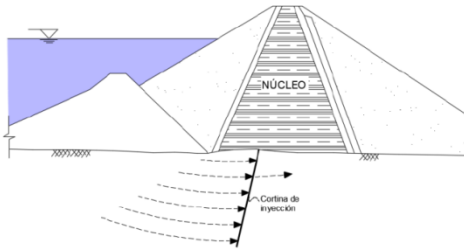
Tratamiento de inyecciones en presas. Adaptado de "Construction and design of cement grouting" de Hously, A.C. (1990).
